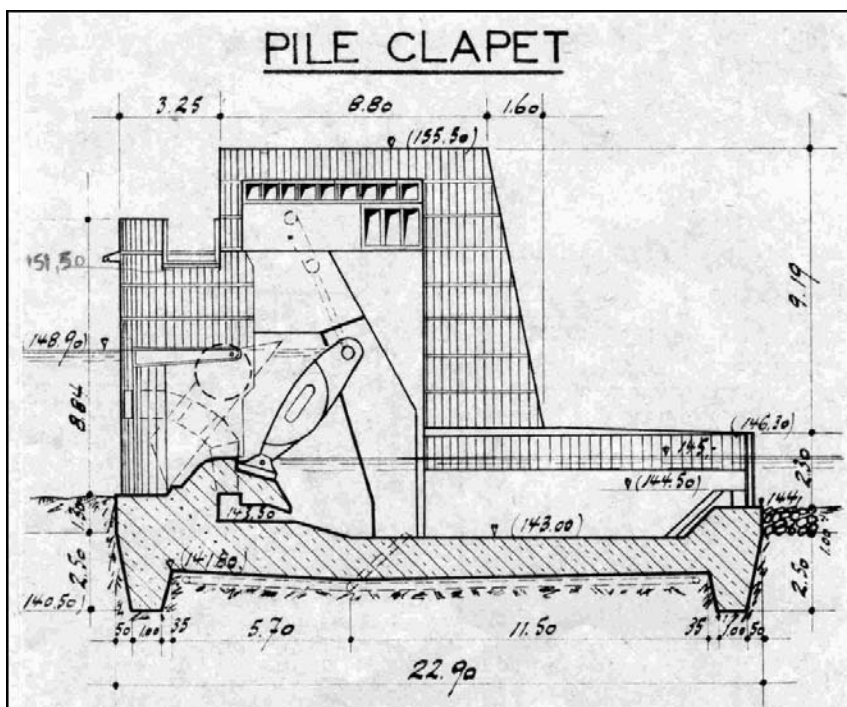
Vue en coupe des piles clapet du barrage de Koenigsmacker (cotes NGF)
